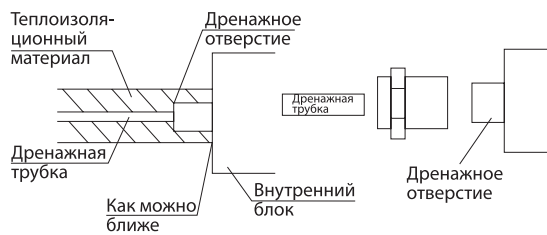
Подсоединение дренажной трубки к внутреннему блоку
